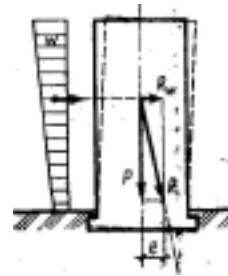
Схема устойчивой работы здания на ветровую нагрузку:
